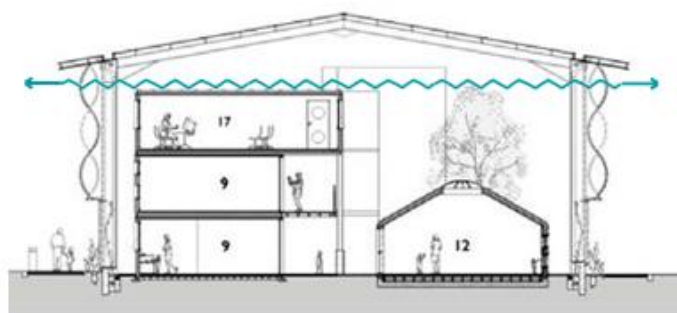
Corte A-A Centro Fawood - Ventilación
